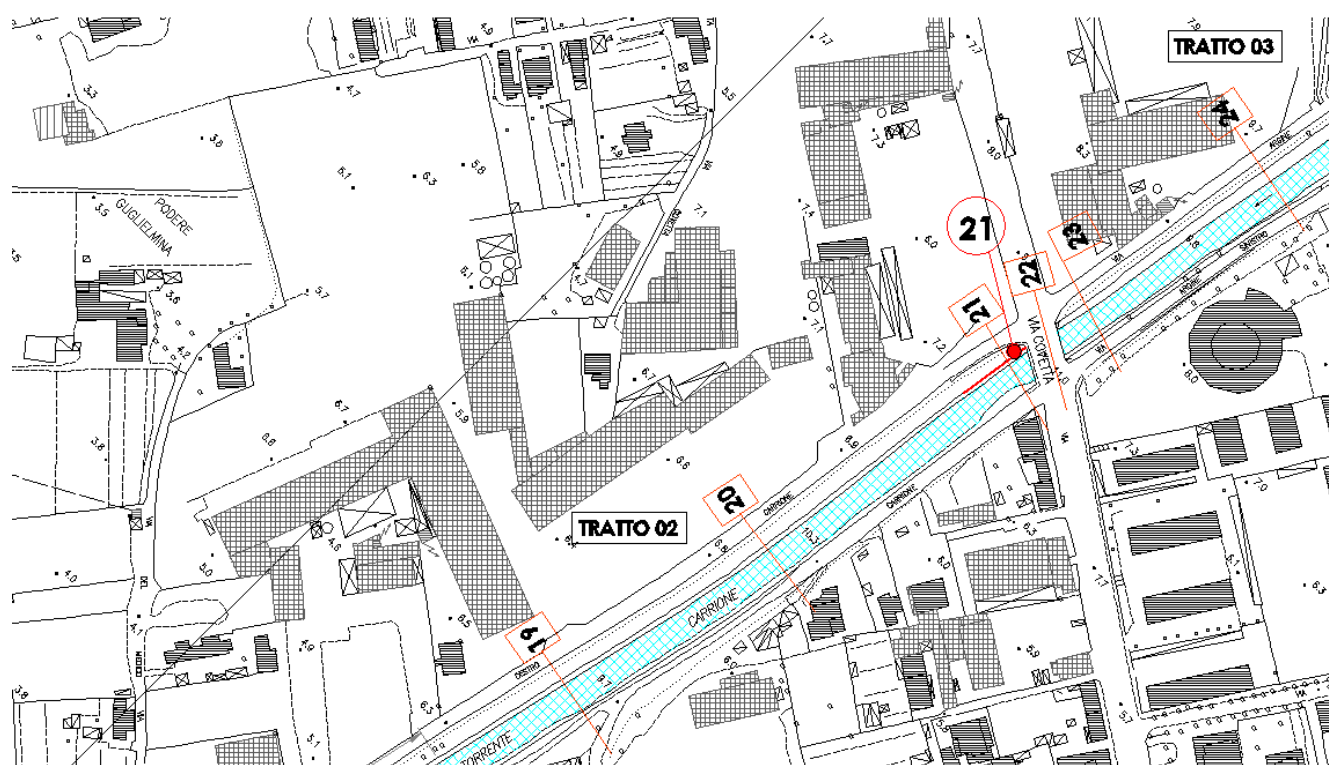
Inquadramento planimetrico – Tratto 02 – Sponda destra
